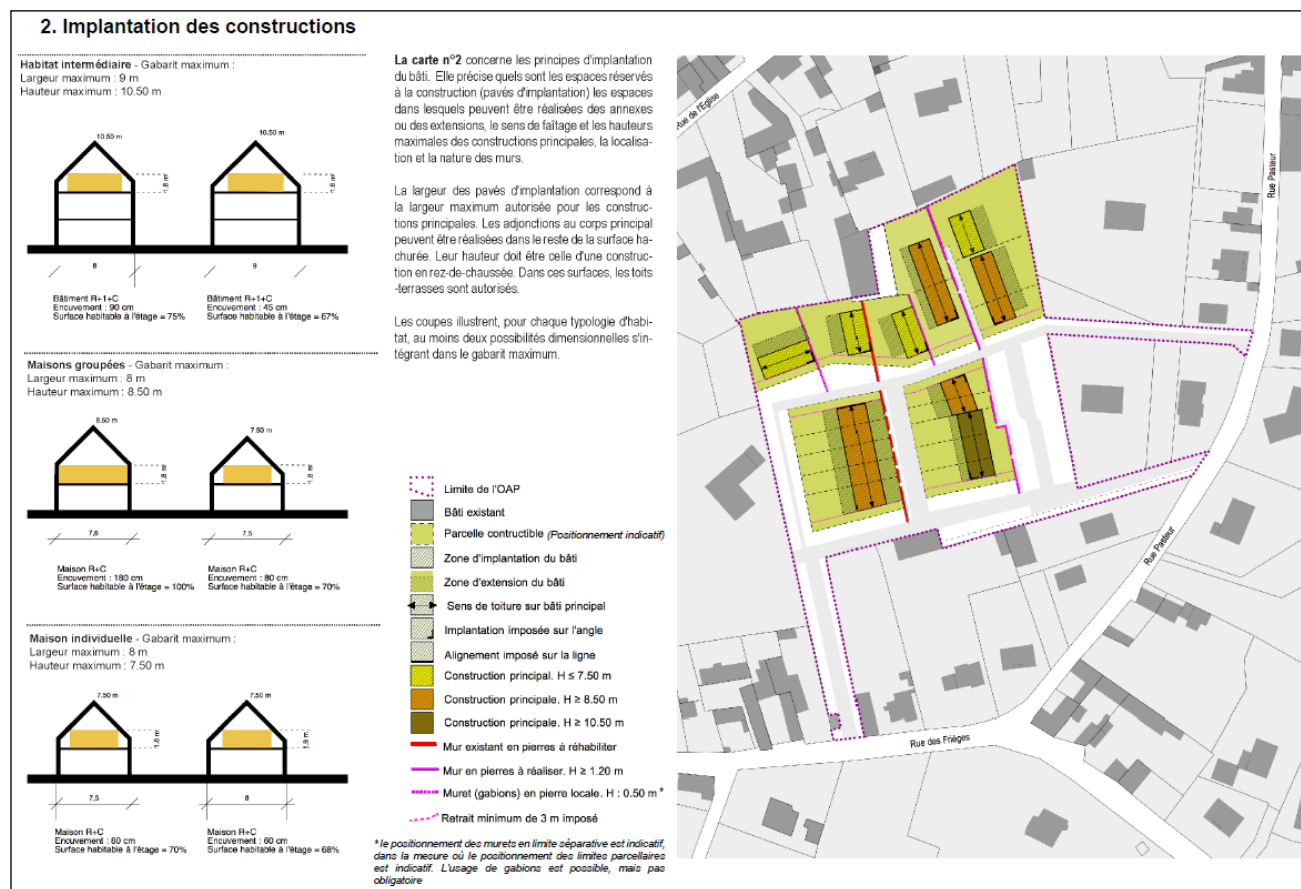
Principes d'implantation des constructions (extrait du document n°4)
